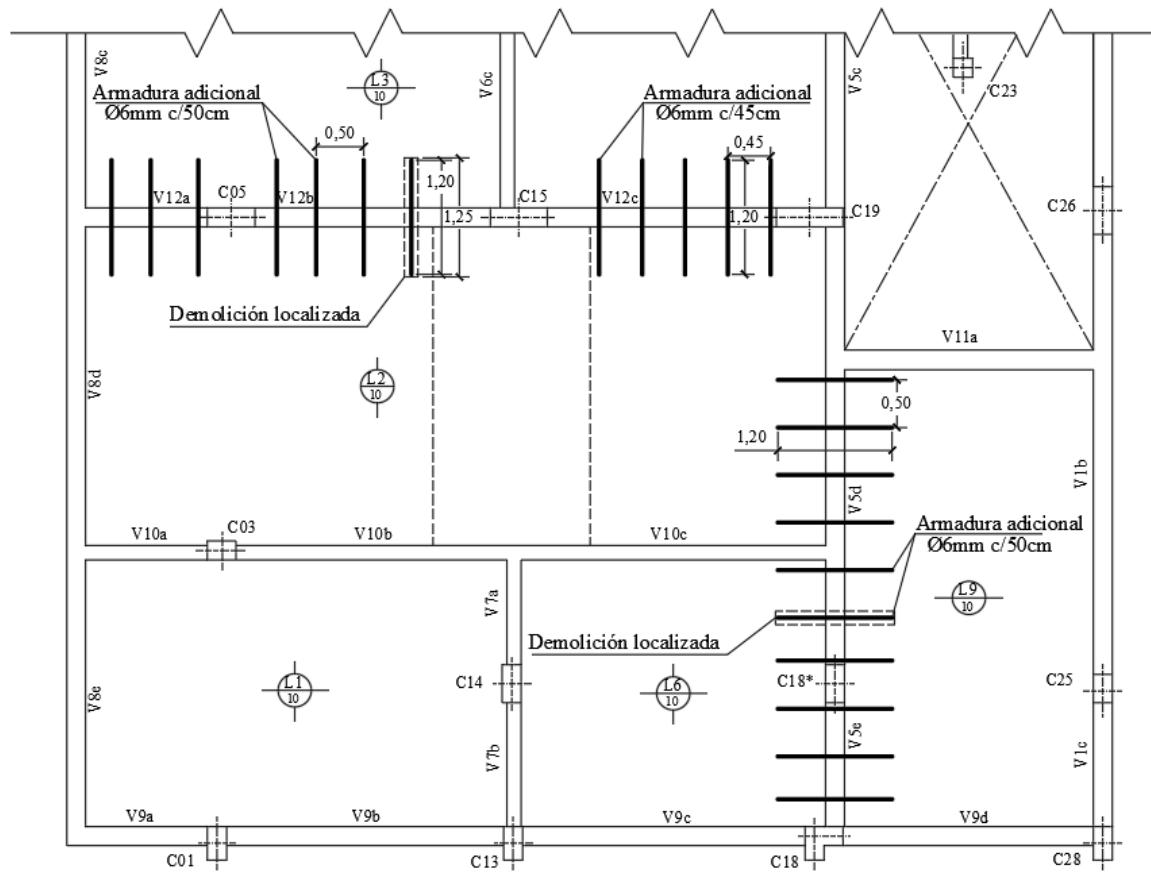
Planta de losas con armadura adicional en el apoyo entre losas L2/L3, L2/L9 y L6/L9.
